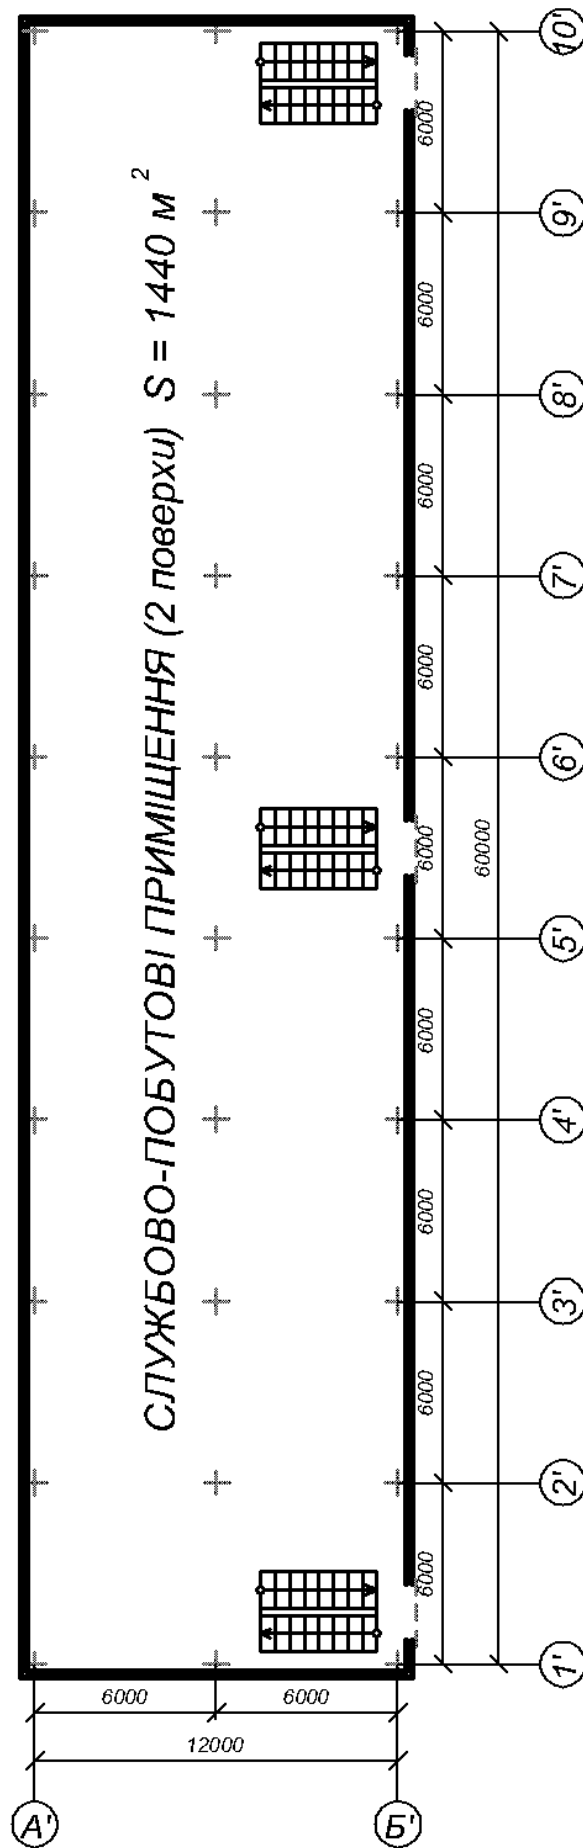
Схема планування службово-побутових приміщень цеху
